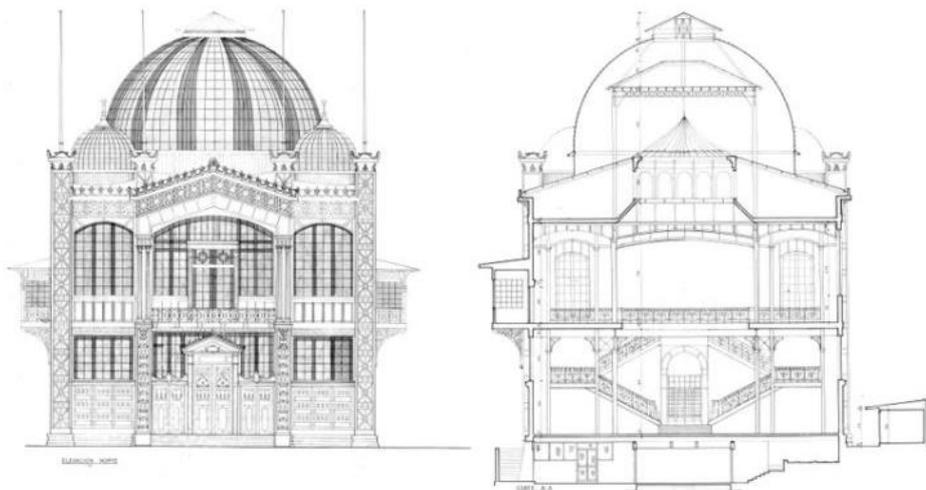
Alzado Norte y sección del Pabellón París. (Artequin, 2020)
